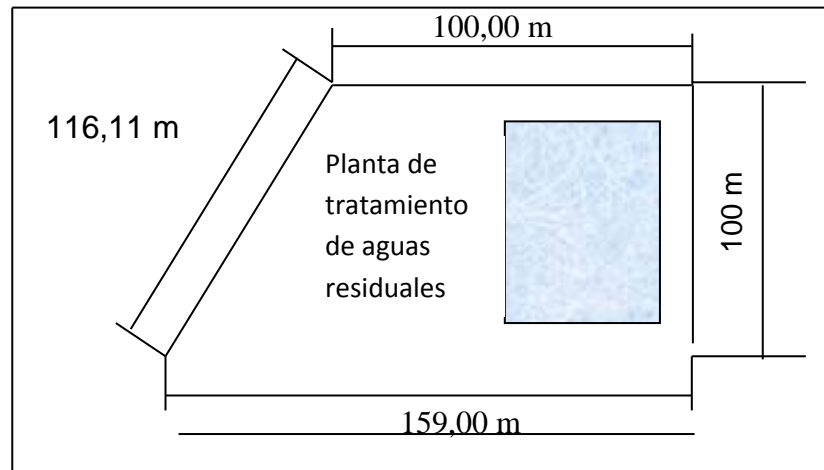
Área de instalación estructural de la planta de tratamiento
